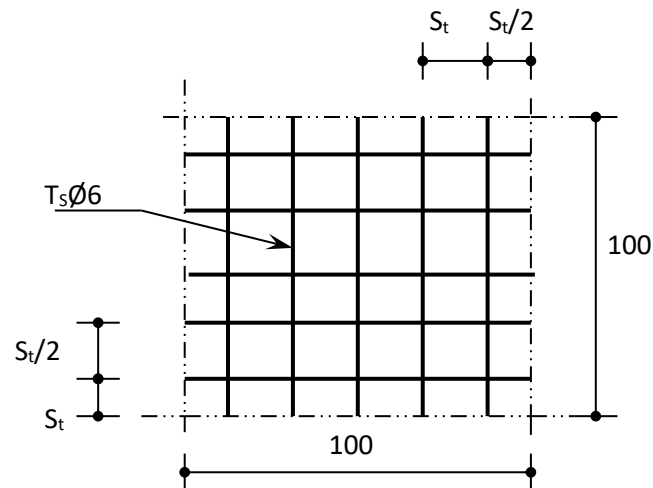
Disposition constructive des armatures de la dalle de compression.
